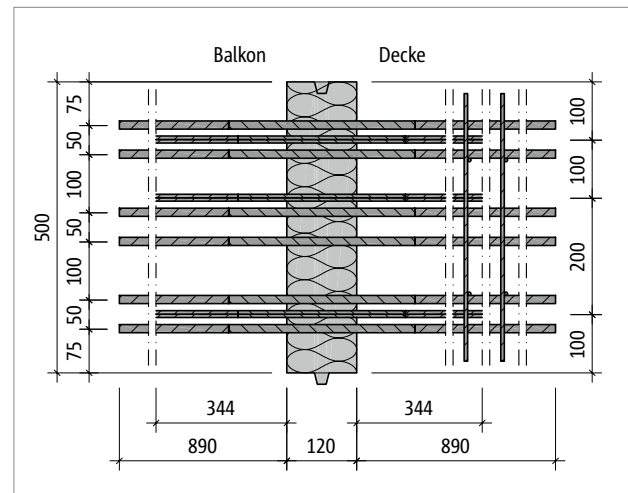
Schöck Isokorb® XT Typ DP-MM6-VV1: Grundriss
